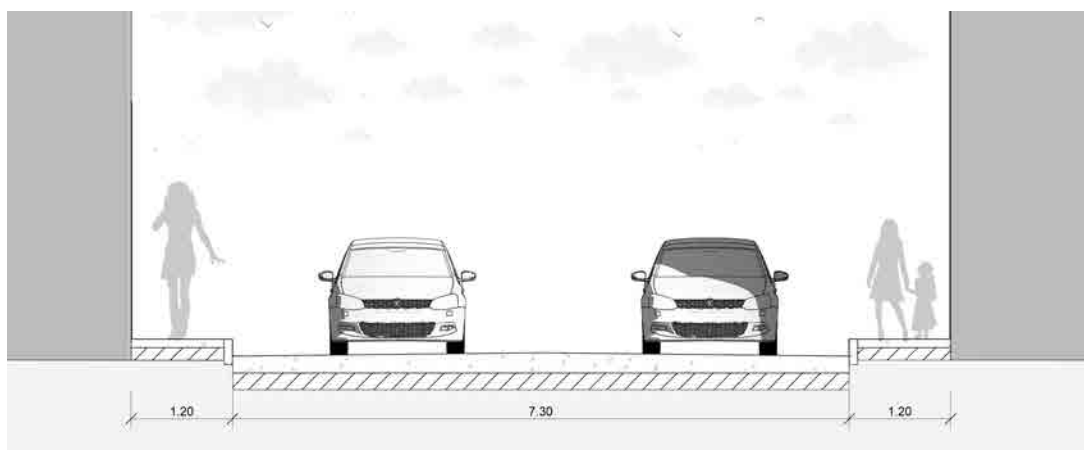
Sección. Fuente y elaboración: Autores.
